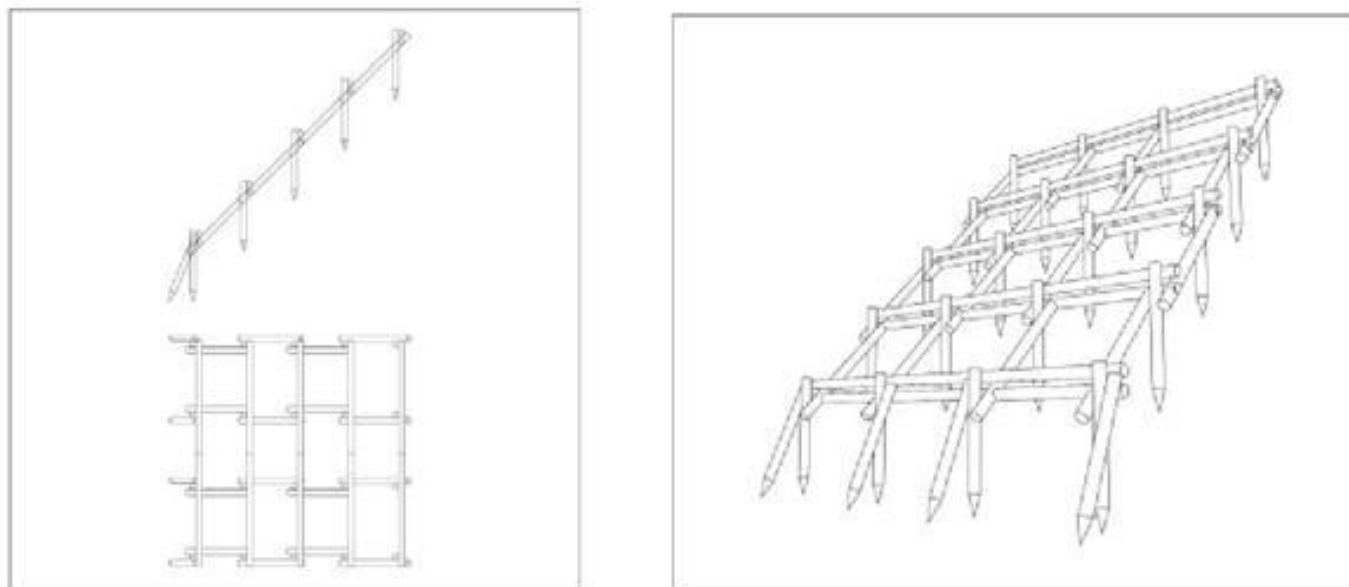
Sezione e pianta (a sinistra) e prospettiva (a destra) della grata Vesuvio sec. Menegazzi.
